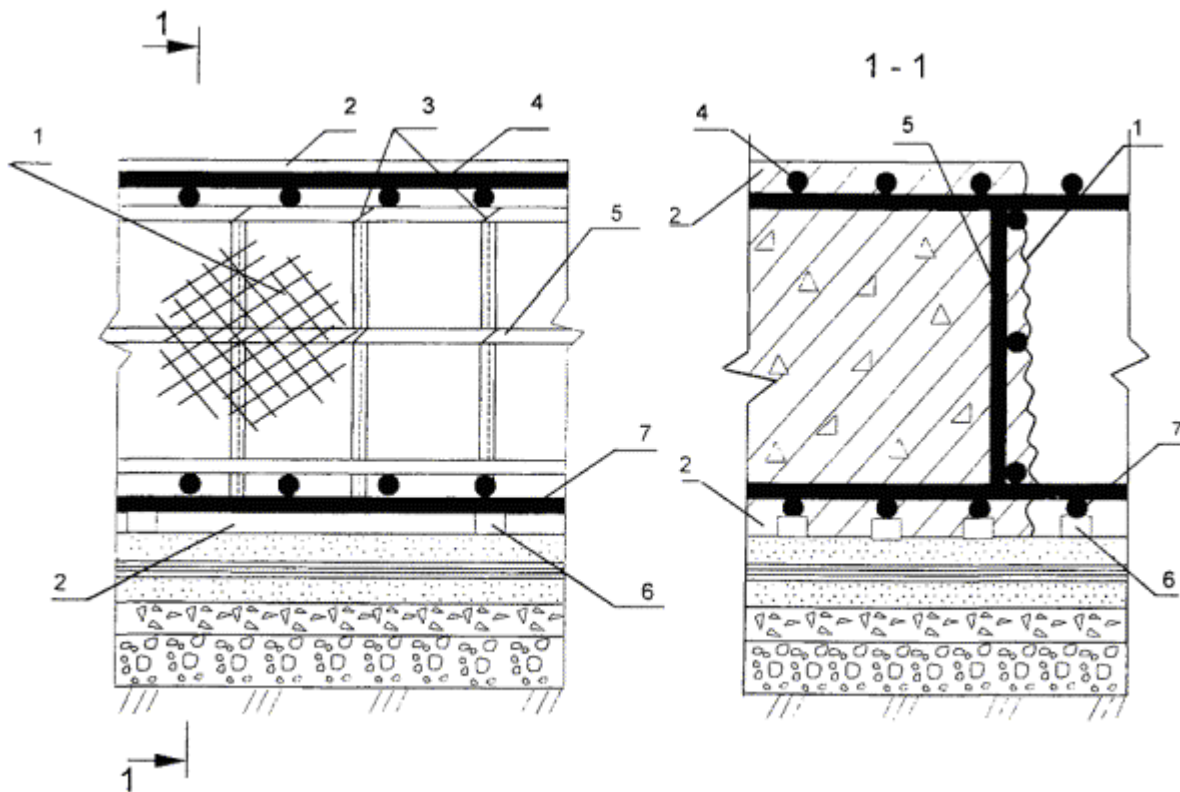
Конструктивна схема робочого шва: 1 - металева сітка; 2 - захисний шар бетону; 3 - місця кріплення сітки в'язальним дротом; 4 - верхня арматура; 5 - плоский несучий каркас; 6 - пластикові хомути; 7 - нижня арматура
